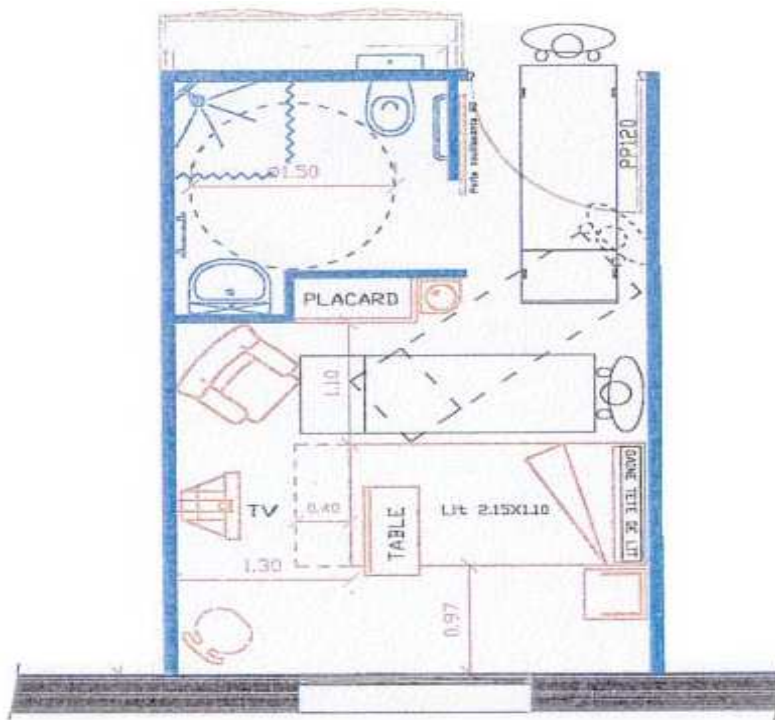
Schéma en construction Plan schématique d'une chambre 2ème variante
